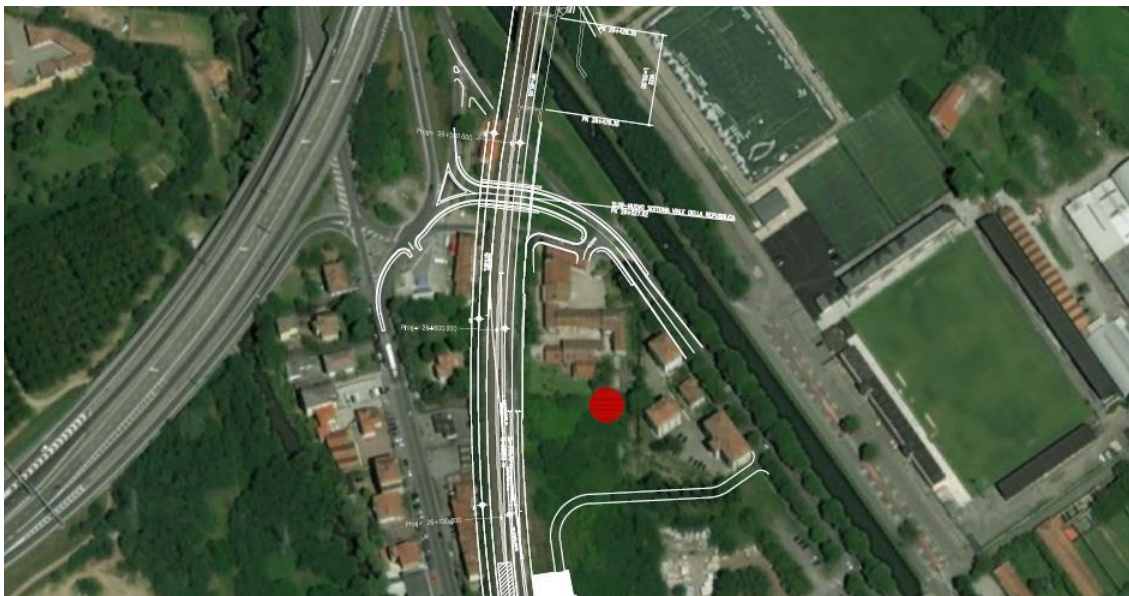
Ubicazione della Chiesa di San Siro detta della Gremegna rispetto alle opere in progetto
